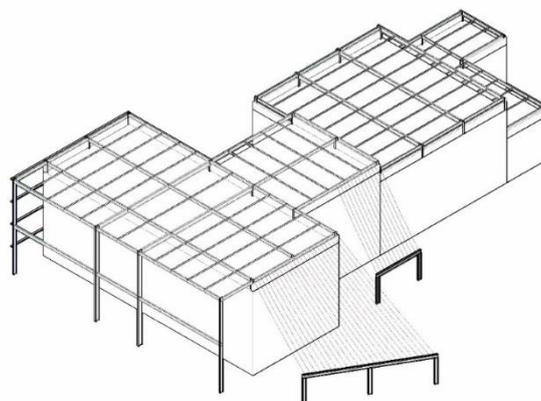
Modelo 3D da estrutura metálica de suporte da cobertura verde.
